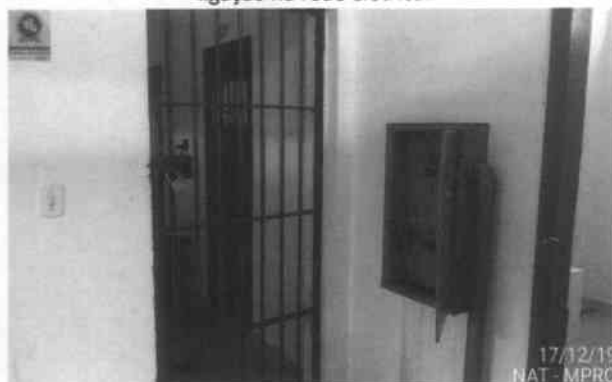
Pavilhão vivência e Pavilhão B – caixas de hidrante sem presença de mangueira.
